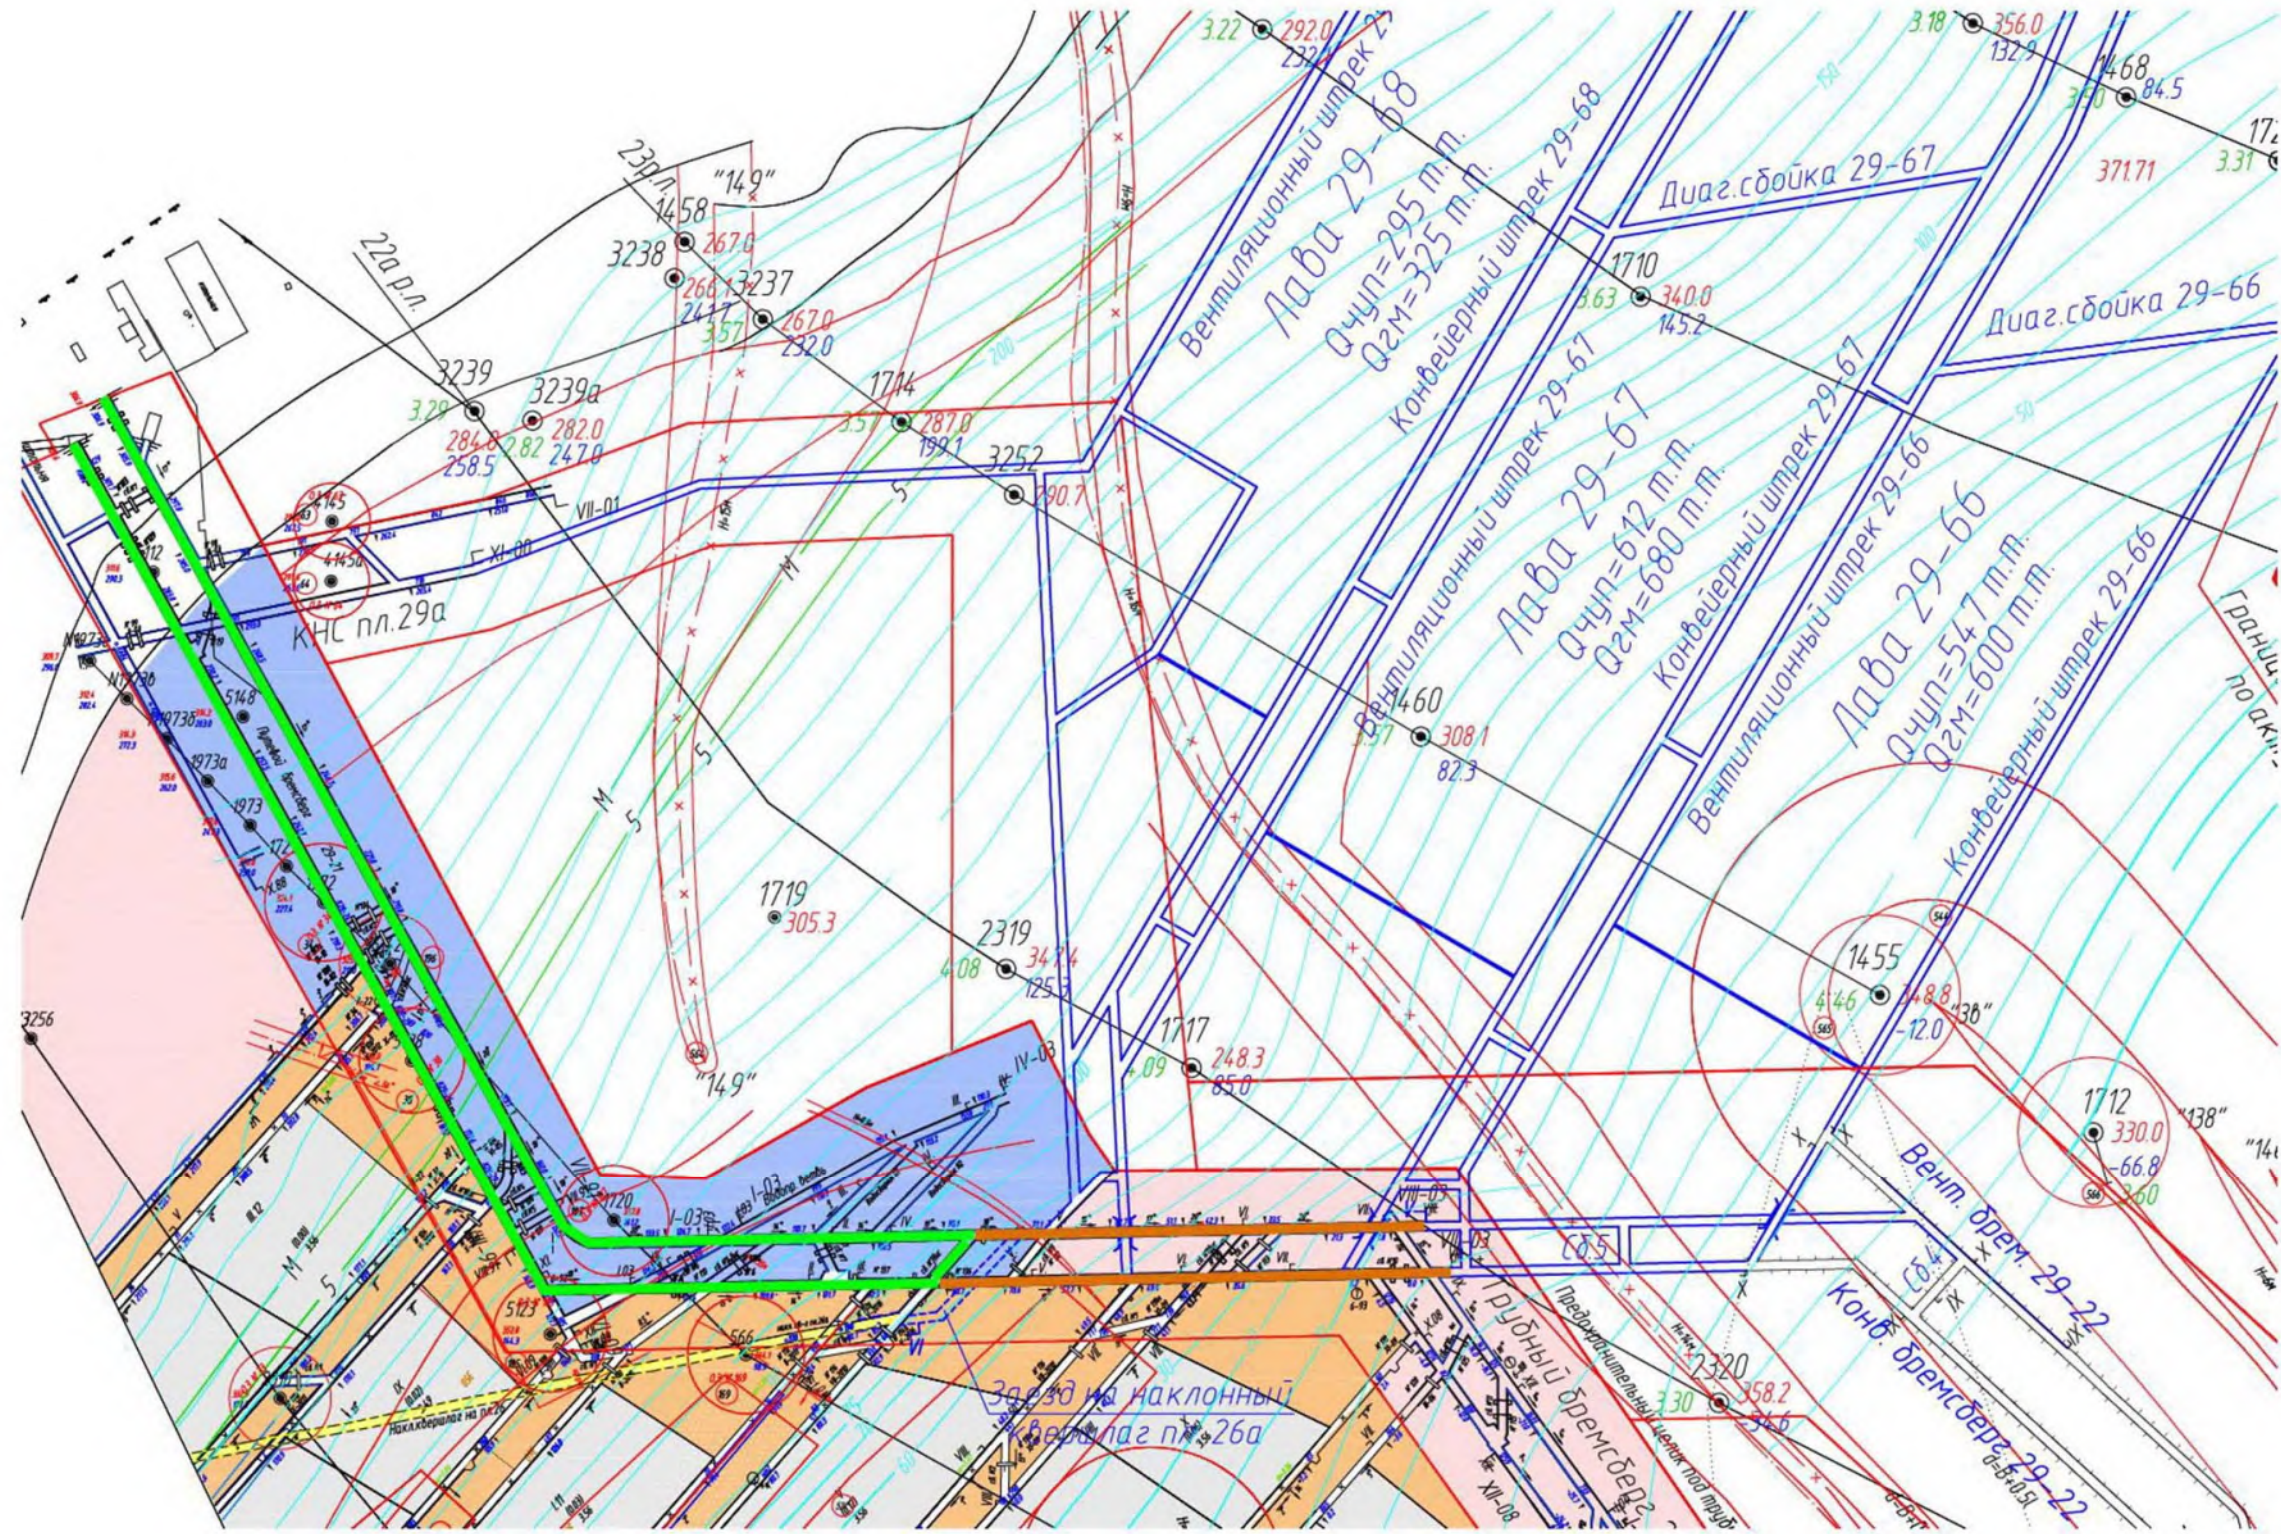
Выкопировка плана горных работ пласта 29а с указанием рассматриваемых выработок
